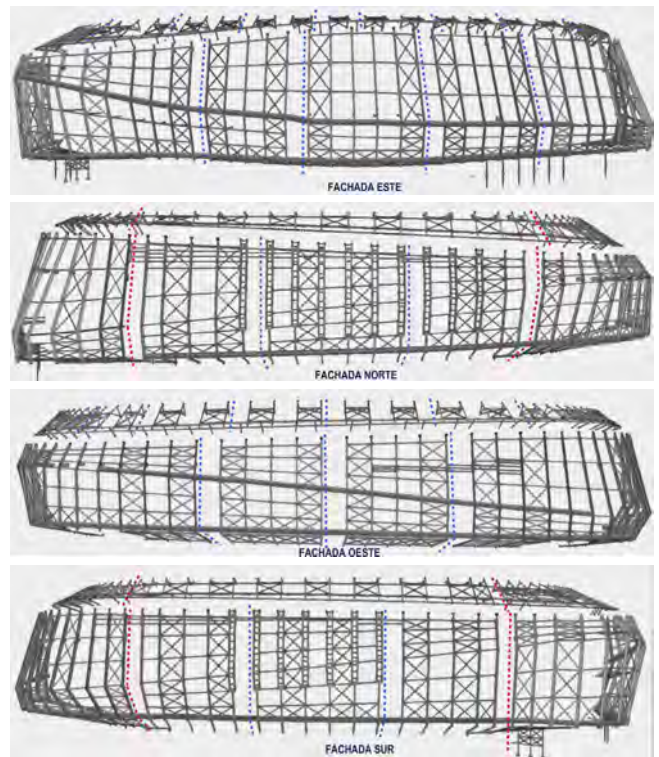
Juntas de dilatación en la fachada. en rojo, las principales entre edificios; en azul, las dispuestas entre módulos.
